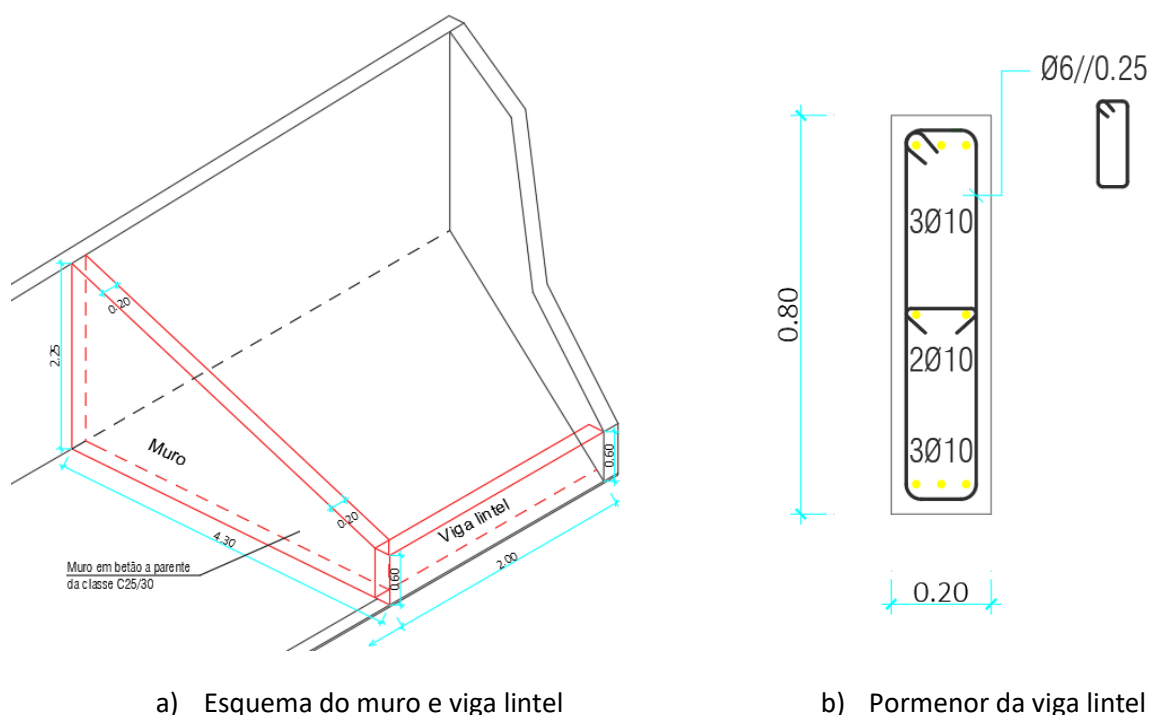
Pormenores das construções necessárias à criação de zona verde.
